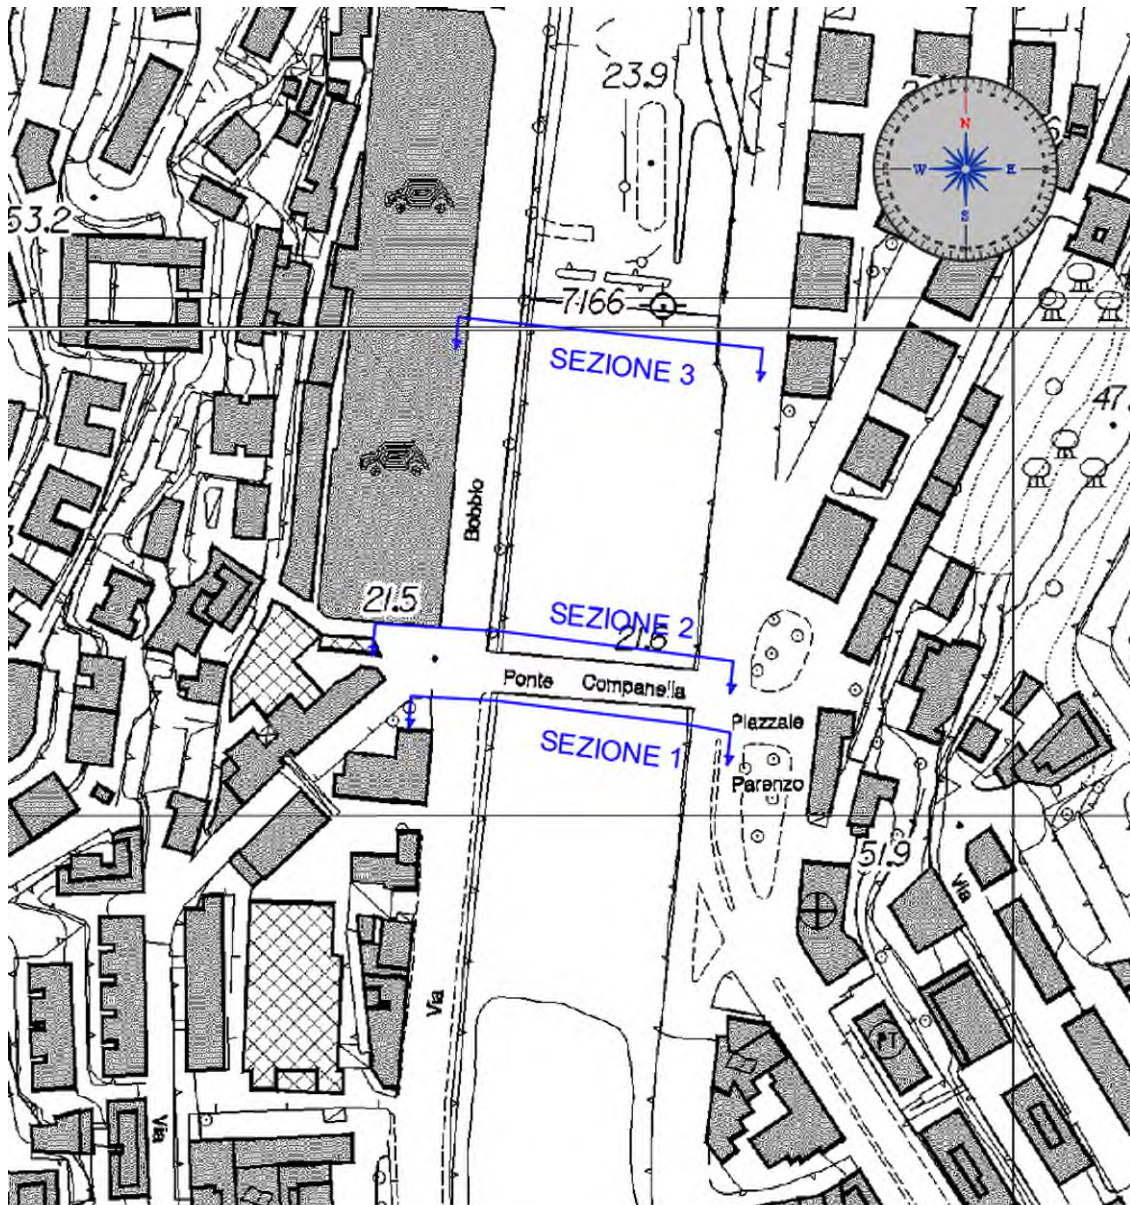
Rappresentazione planimetrica delle sezioni oggetto di rilievo di dettaglio
